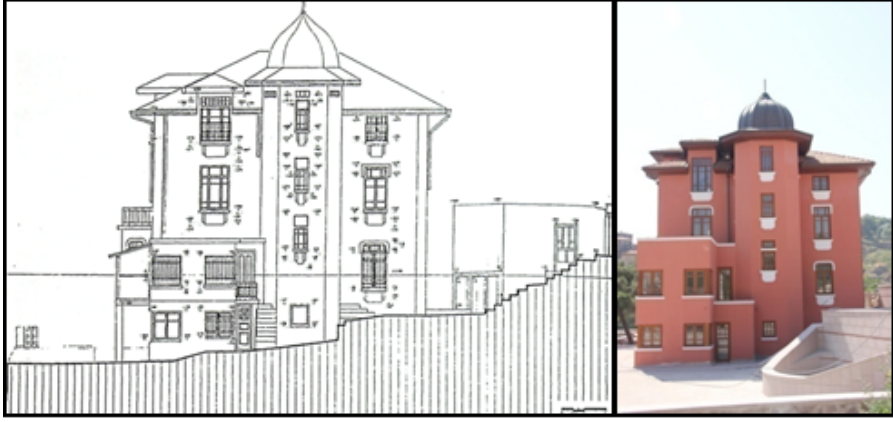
Ankara, Hacıbayram, Ulus'ta Bulunan Bir Yapının Yerleşimi, Kat Planı ve Fotoğrafi [12]
